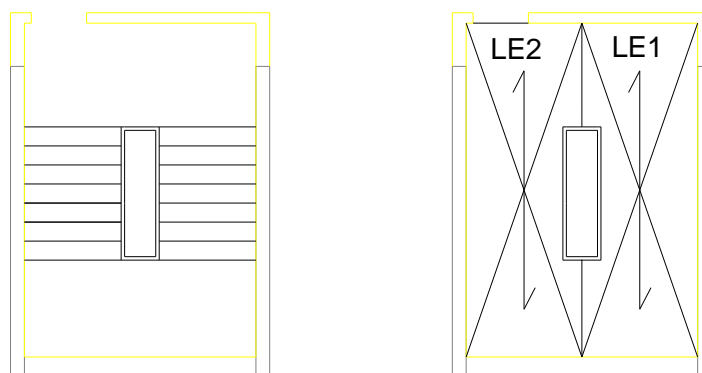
Planta de arquitetura das escadas LE1 e LE2 e Planta estrutural
